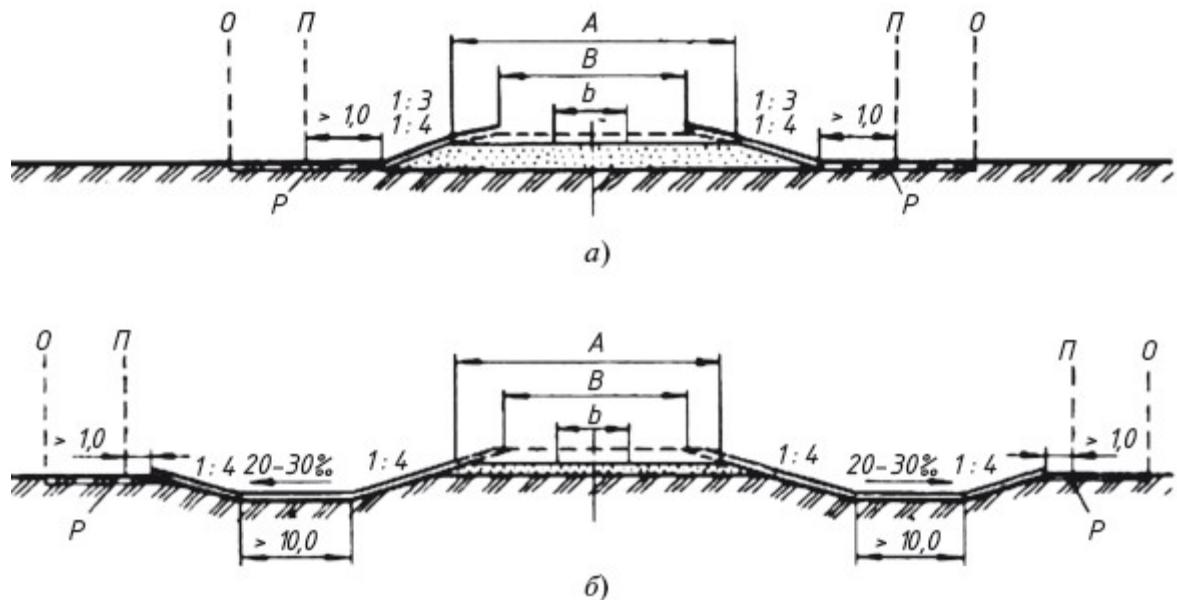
Конструкции земляного полотна в поперечном профиле на насыпях:
